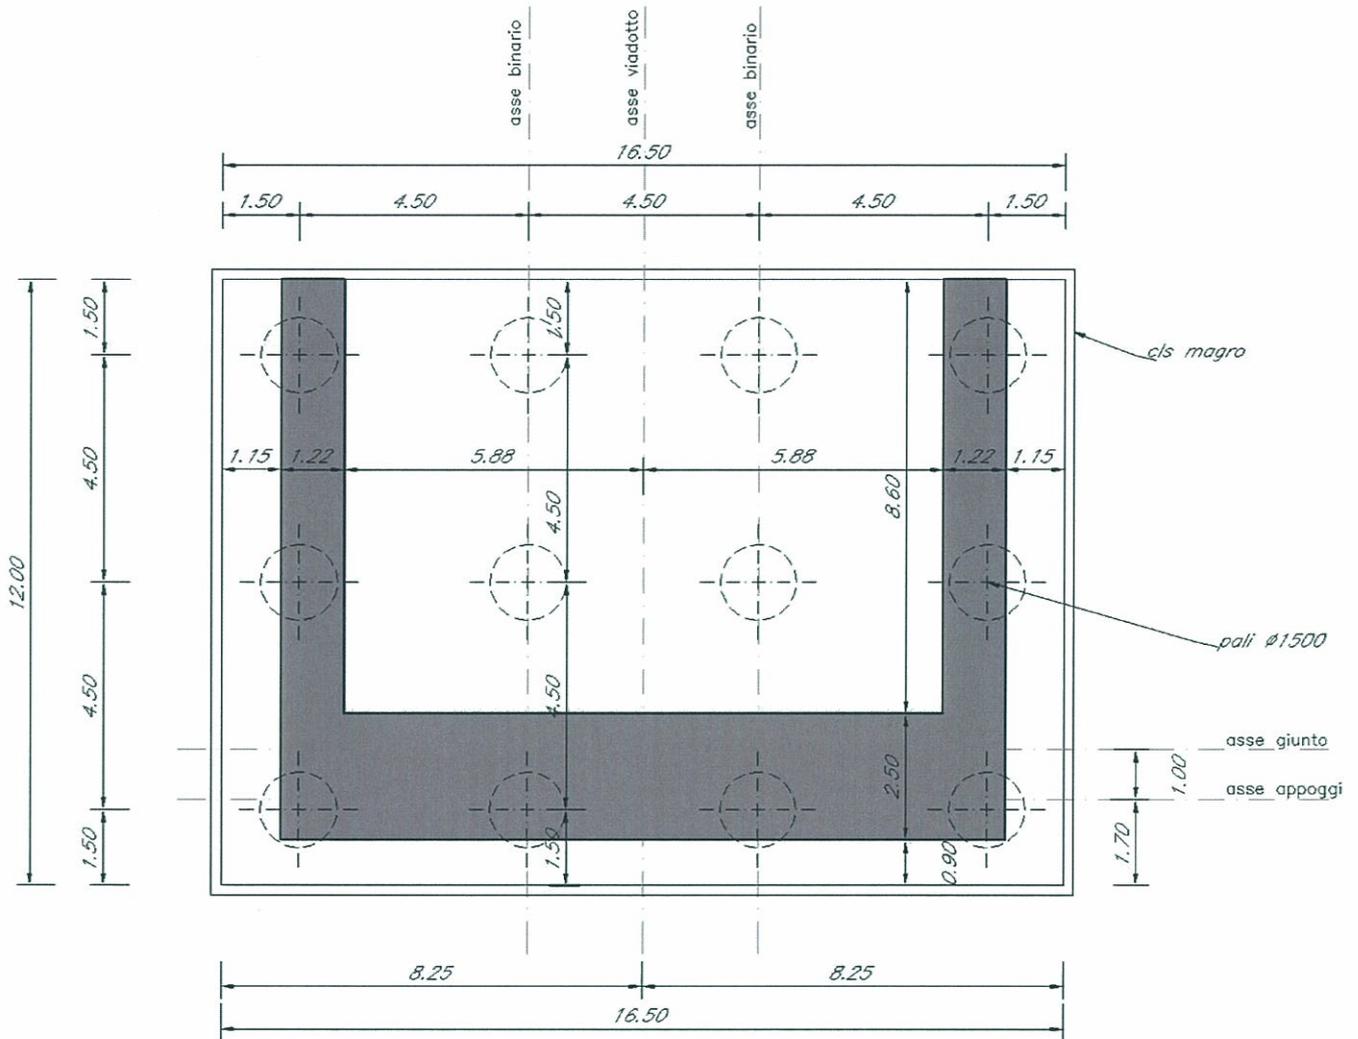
Pianta fondazioni della spalla tipo.
